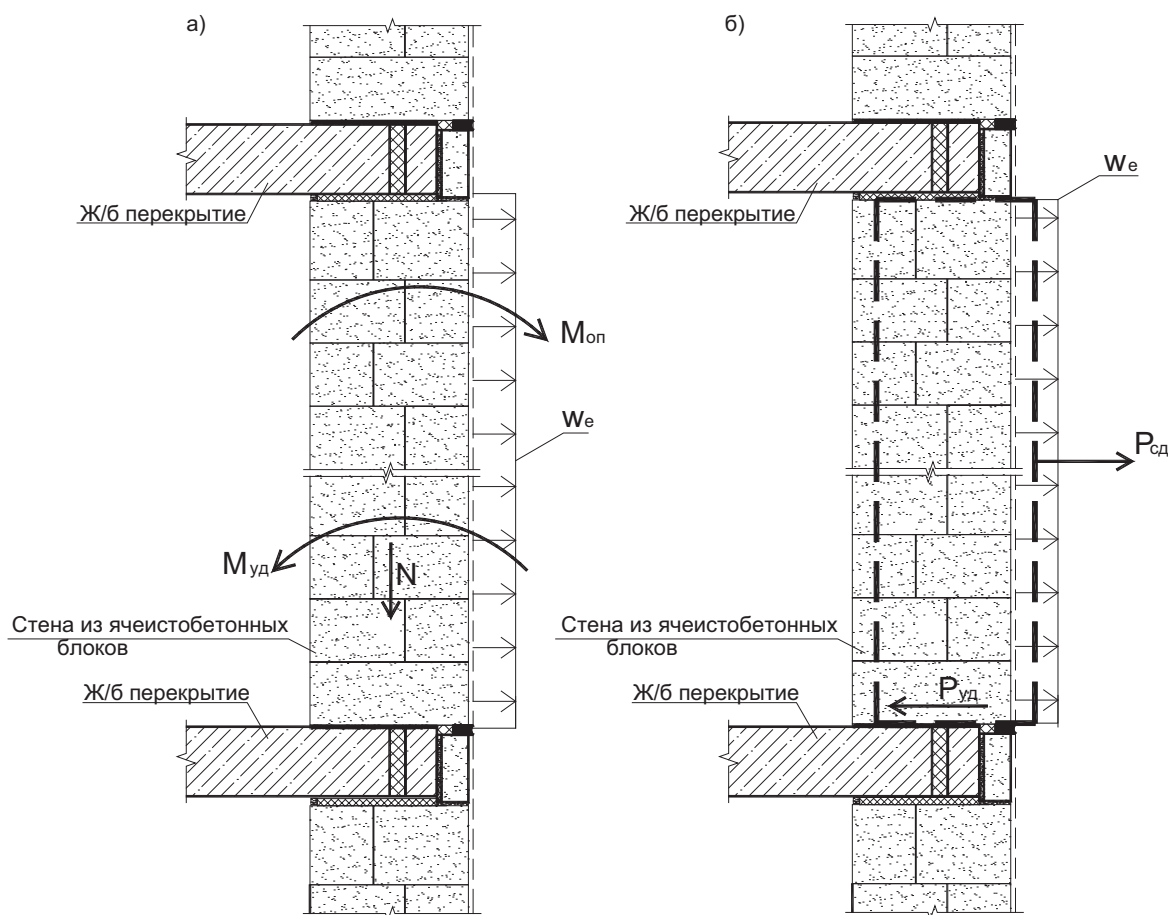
Расчетные схемы поэтажно опертых наружных стен на ветровое воздействие
